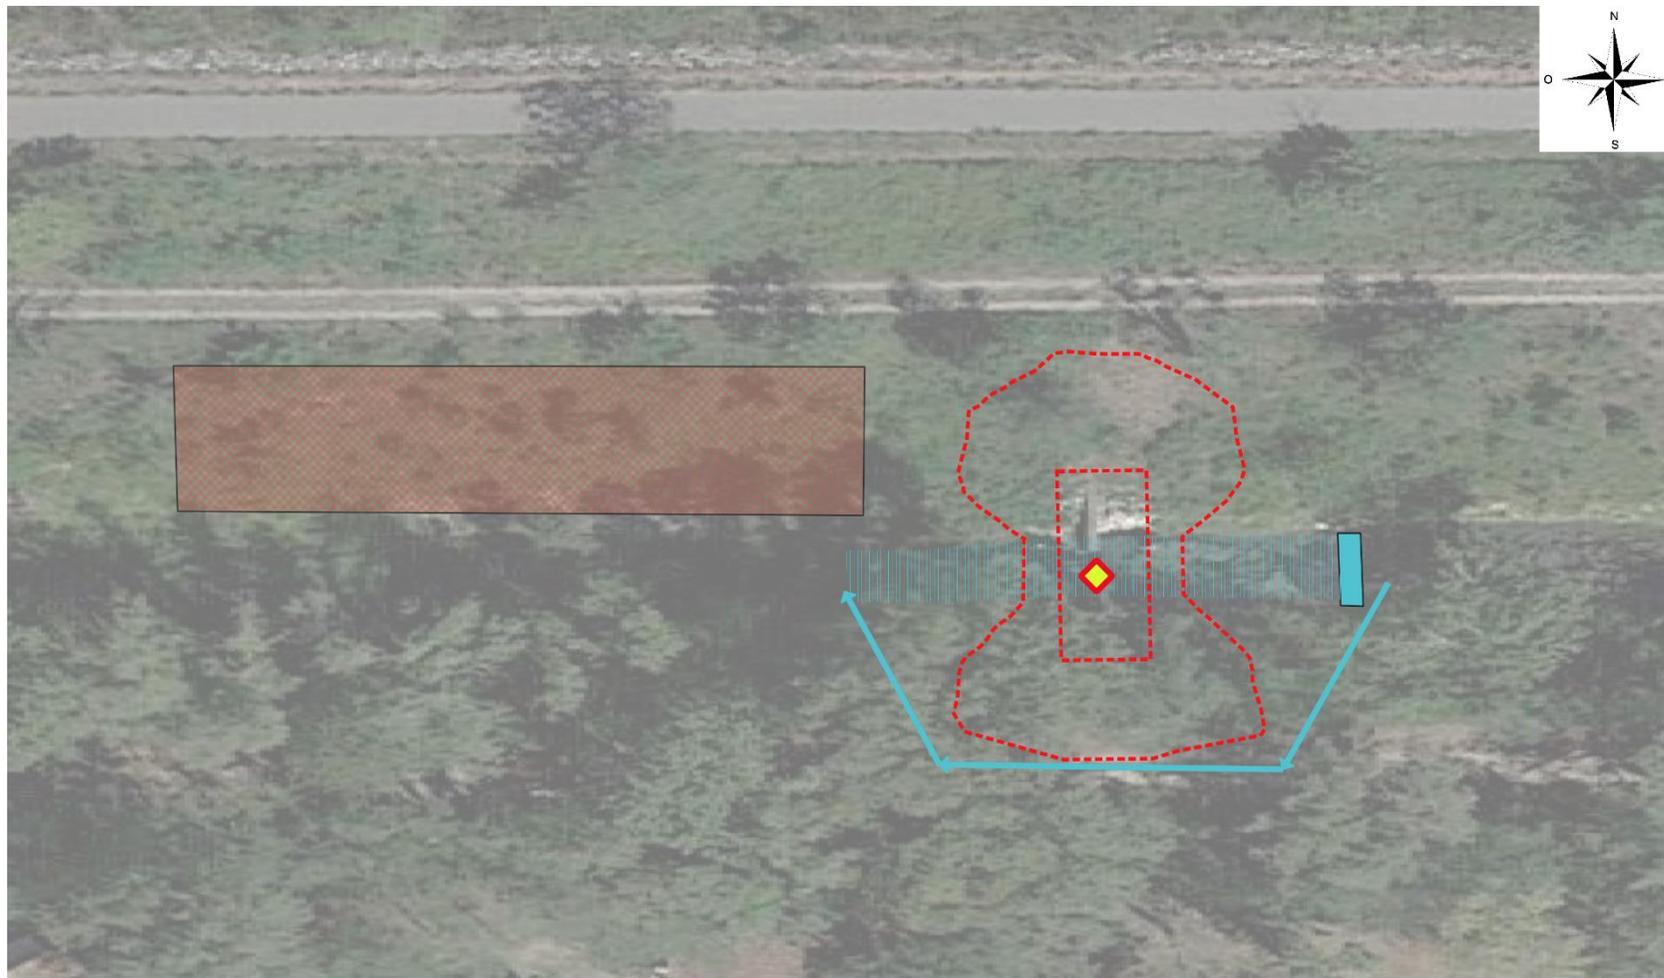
Emprise des travaux - Ouvrage RG Amont
